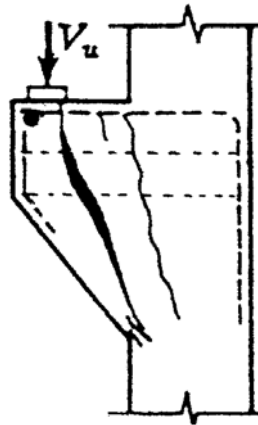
Ruptura por fendilhamento diagonal (MACHADO 1998).
